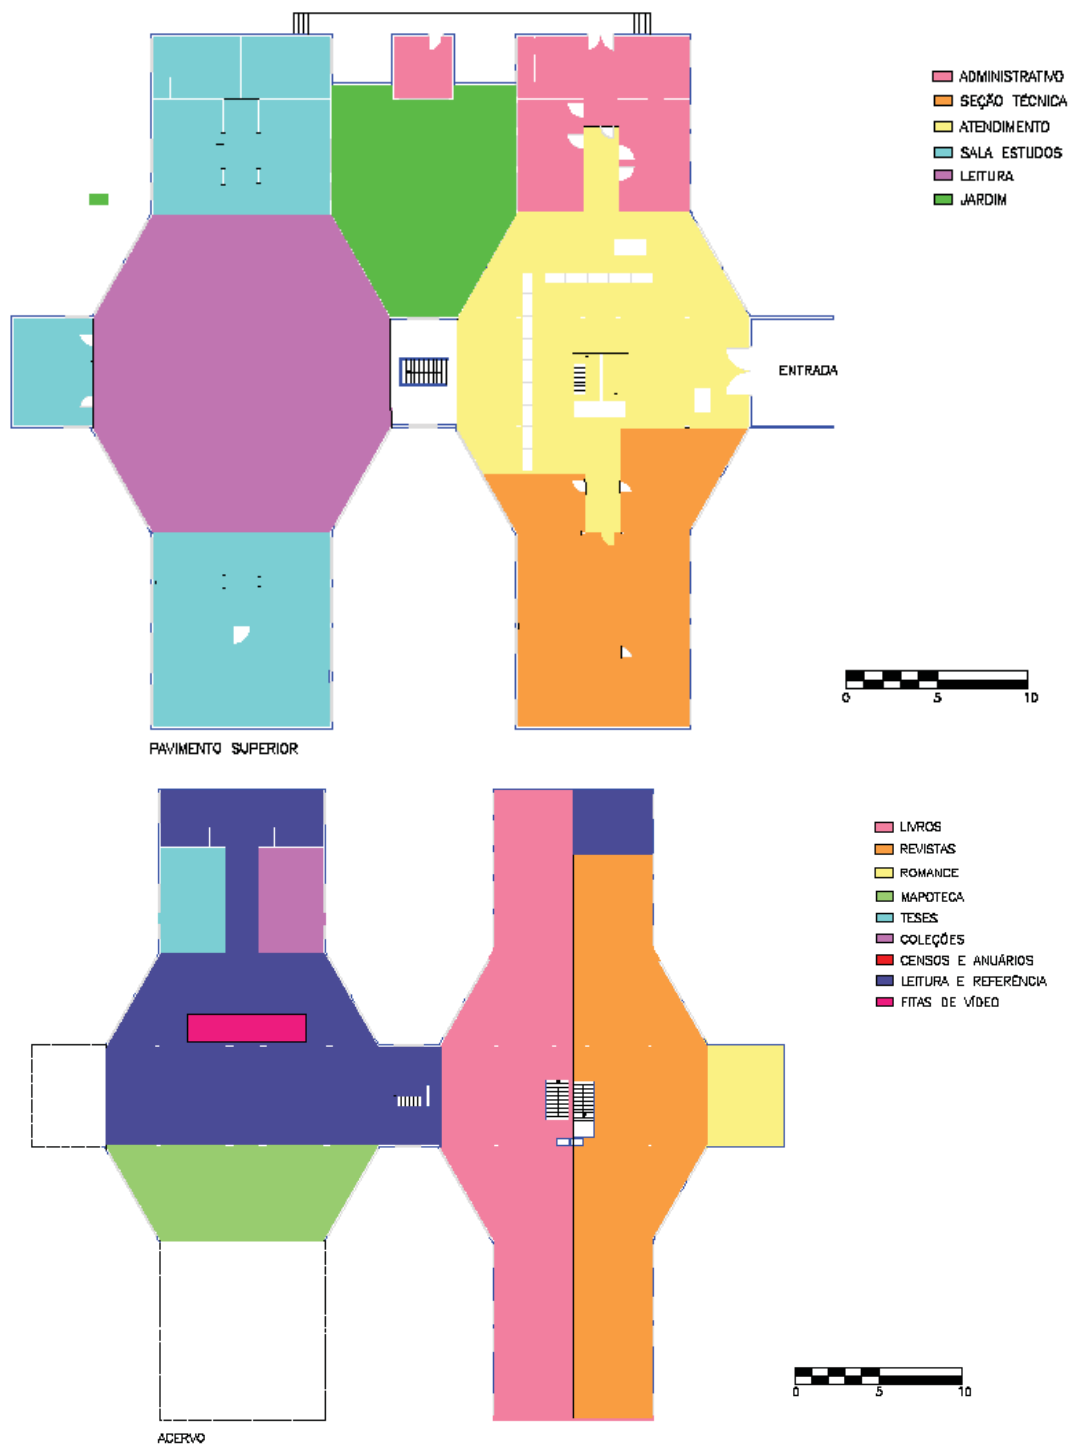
e 5: Pavimento inferior da biblioteca atual (acervo) e Planta do pavimento térreo da Biblioteca atual da FCT. Fonte: estudos desenvolvidos pela autora, 2011.
